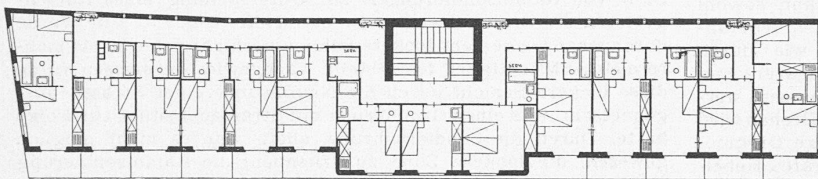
Viertes Obergeschoss (Gästezimmer mit Bad) 1:400. — Clichés «Werk»
